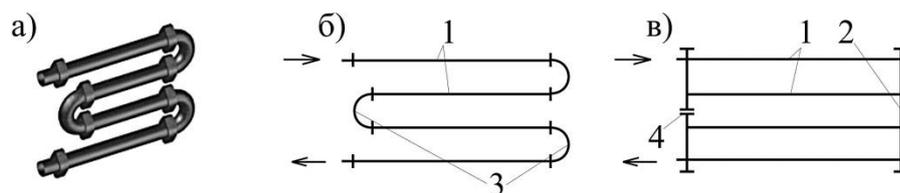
Гладкотрубный отопительный прибор: а – внешний вид; б – змеевиковая форма; в – регистровая форма 1 – нитки; 2 – колонка; 3 – калачи; 4 – заглушка
